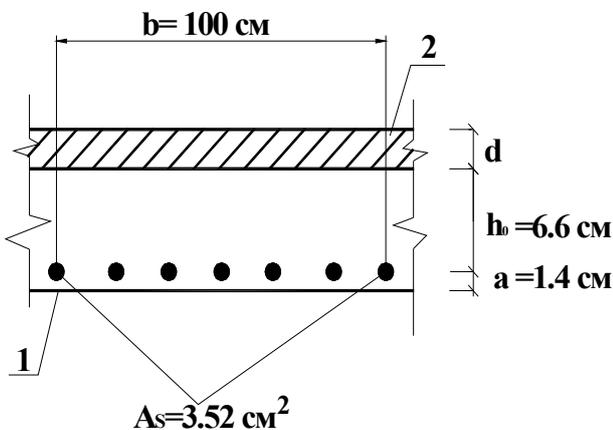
Расчетная схема усиления плиты наращиванием сверху:
